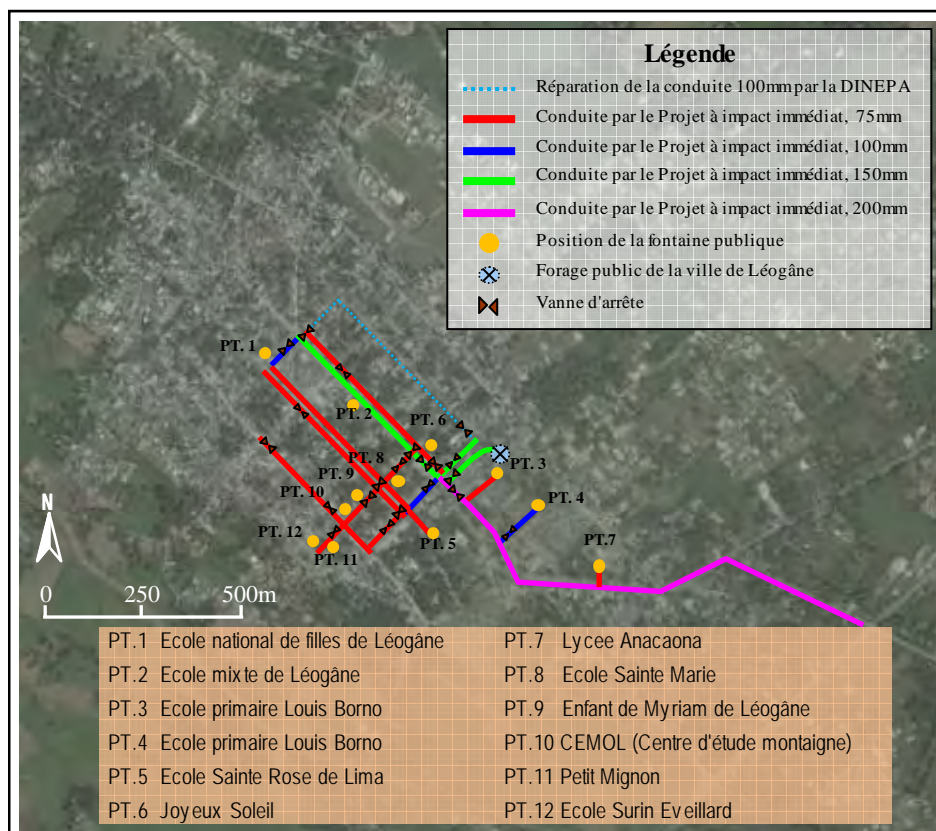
Plan d'emplacement du système d'alimentation en eau
